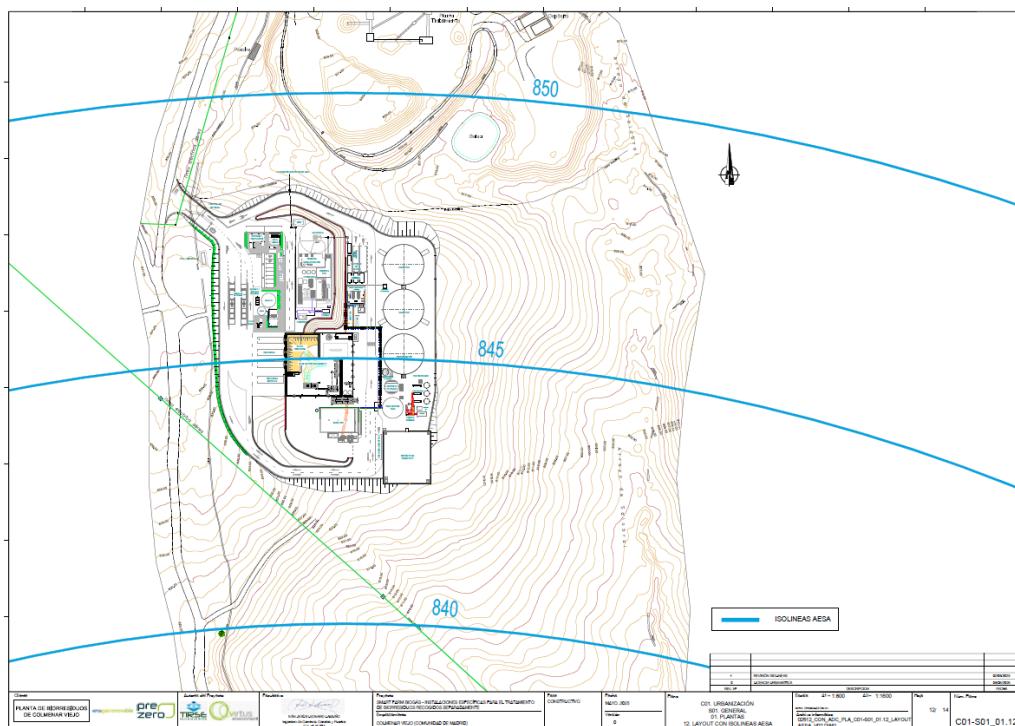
Plano de detalle de las plataformas y cotas de las construcciones
